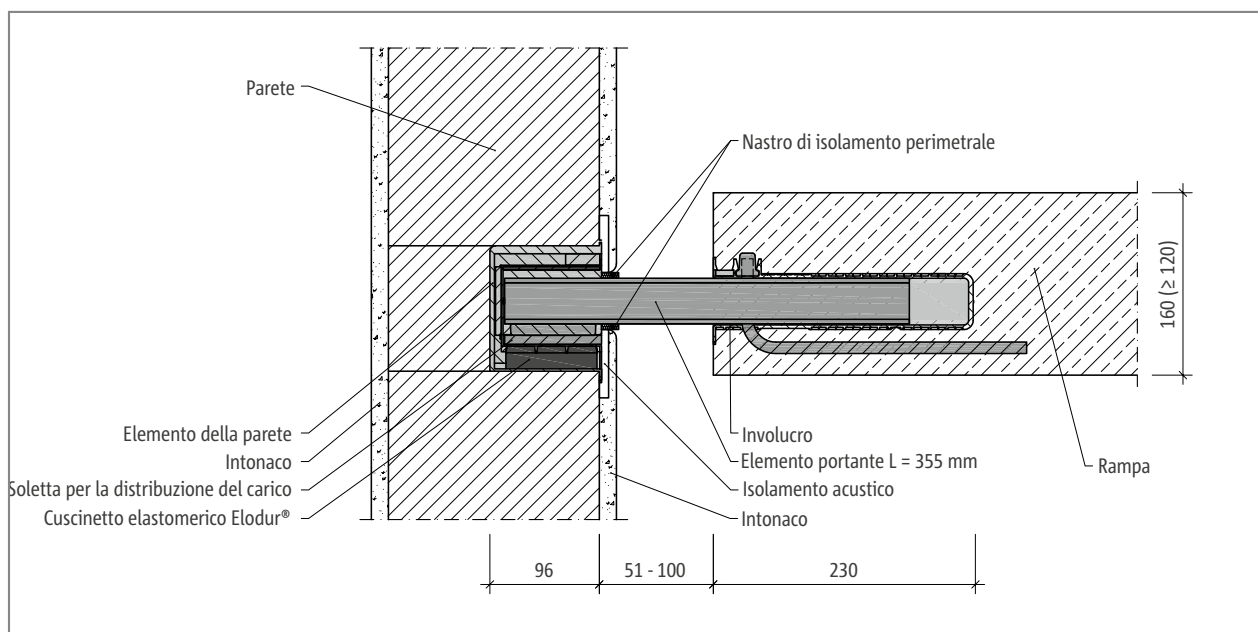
Schöck Tronsole® tipo Q-FV-XL o Q-A2-XL, sezione costruttiva
